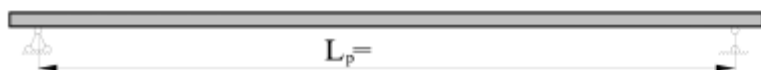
Расчетная схема балки с указанием действующих нагрузок
